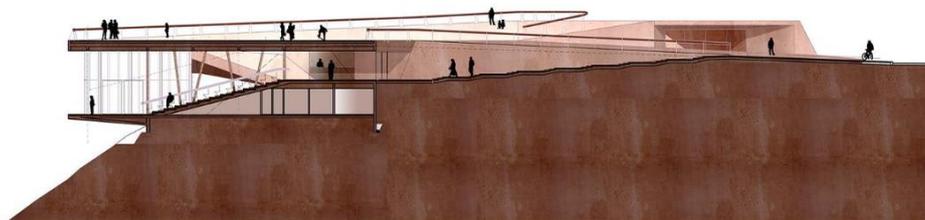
Axonometría edificio nueva planta museo, al filo del acantilado
